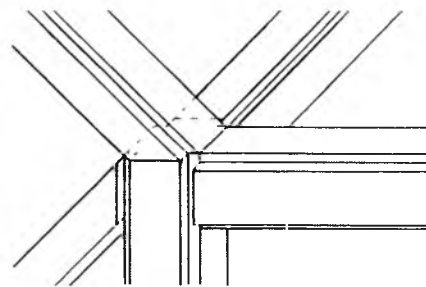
Универсальный узел соединения элементов каркаса строительных конструкций
